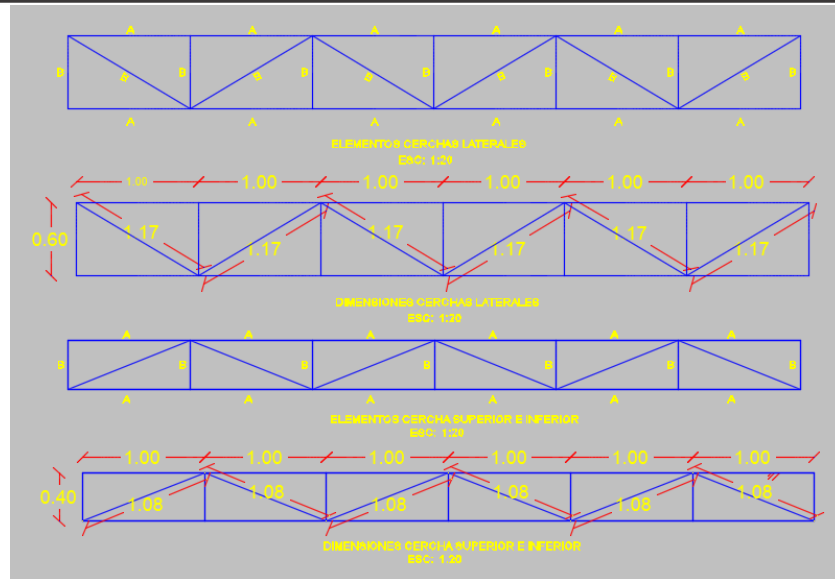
Elementos y dimensiones cercha Viaducto N8-16
